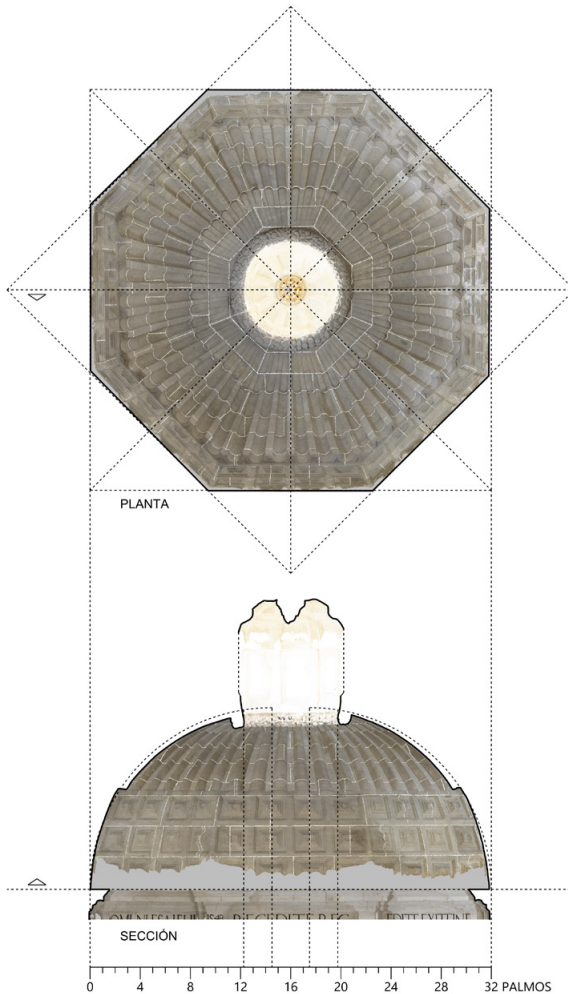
Planta vista desde abajo y sección transversal del ochavo de Orihuela. Fuente: el autor.
